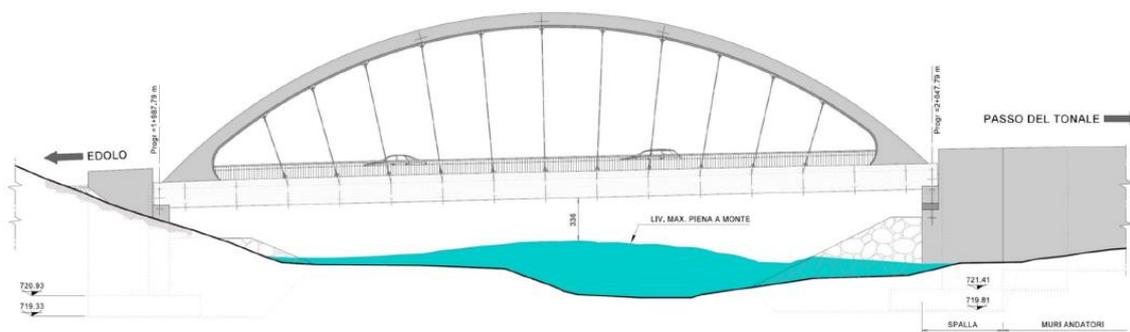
Ponte sul Fiume Oglio – Prospetto Ovest
